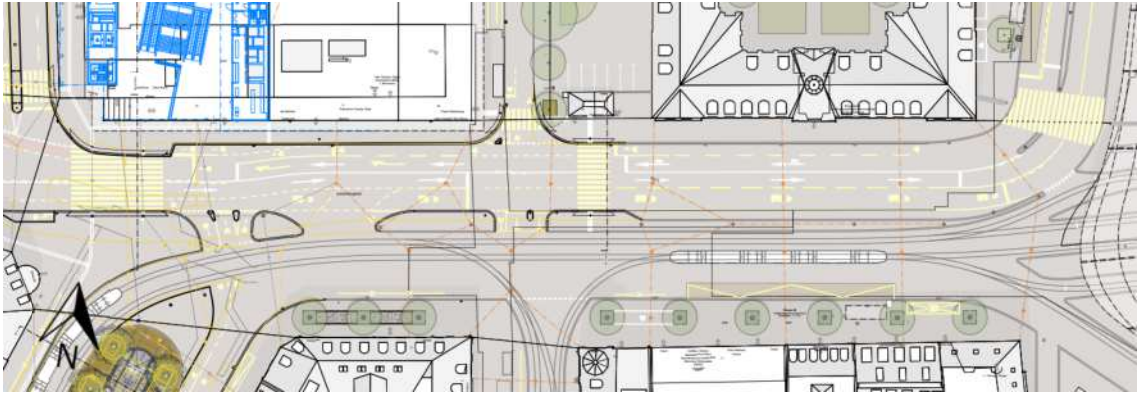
Gestaltungsplan West Laupenstrasse (Plan Nr. 1-21 / 05.04.2023)
